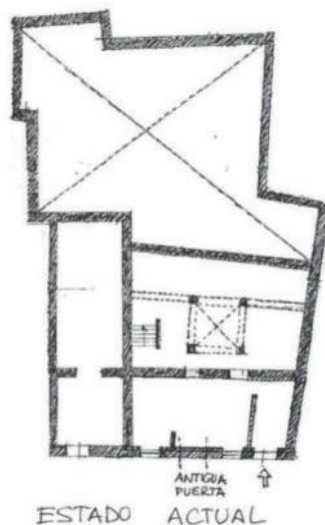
Planta de la casa de la calle Santisteban nº 5.
